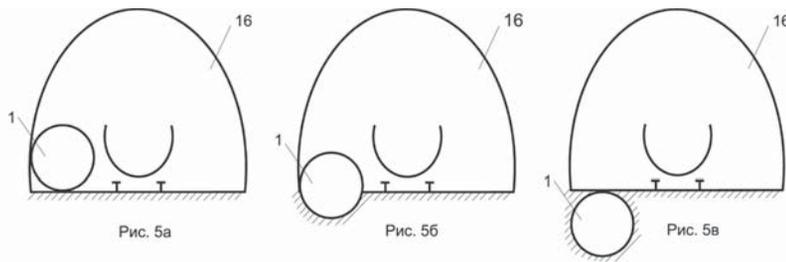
Схемы вариантов возможного размещения эвакуатора в поперечном сечении горной выработки
